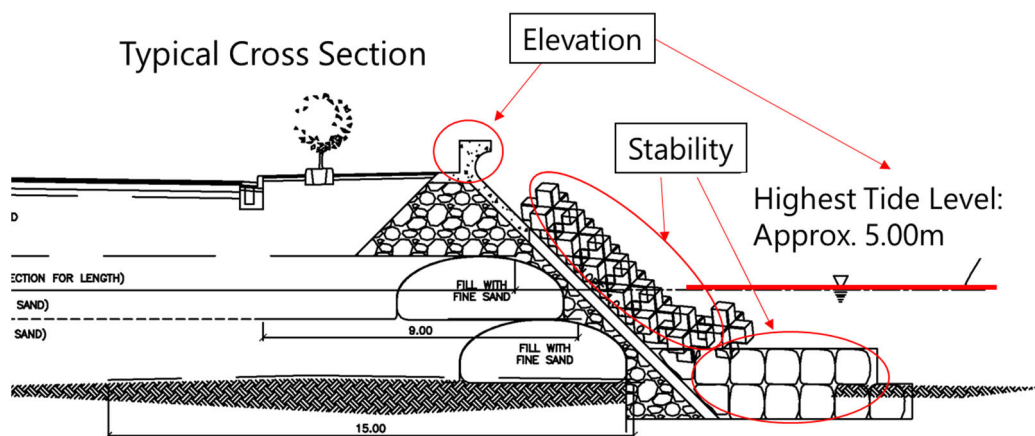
ダバオ市 Coastal Road の標準断面図
